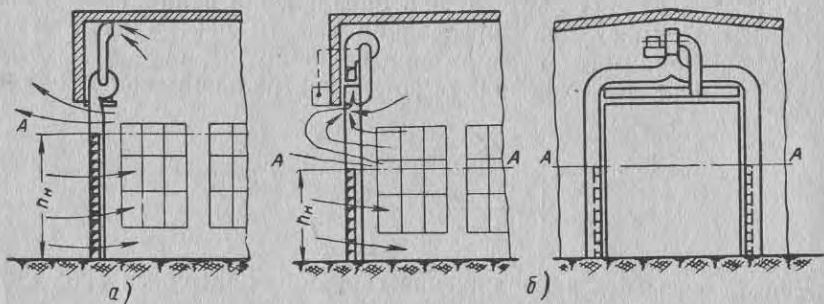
Устройство воздушной завесы в низких зданиях без фонарей и верхнего света:
